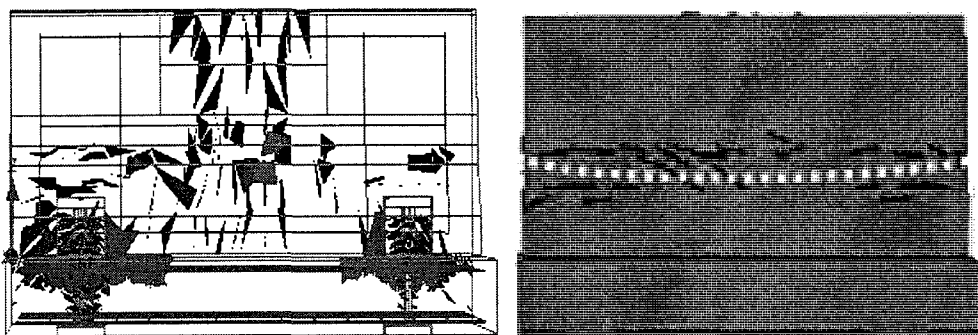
26: Fissuration du parapet en BRF 70MPa-1.5%
